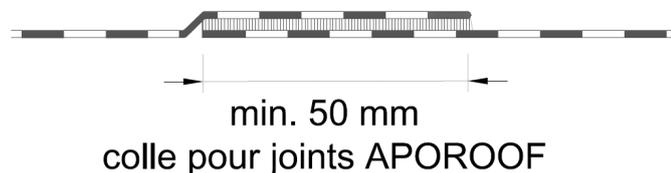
Raccord par recouvrement au moyen de colle pour joints APOROOF
